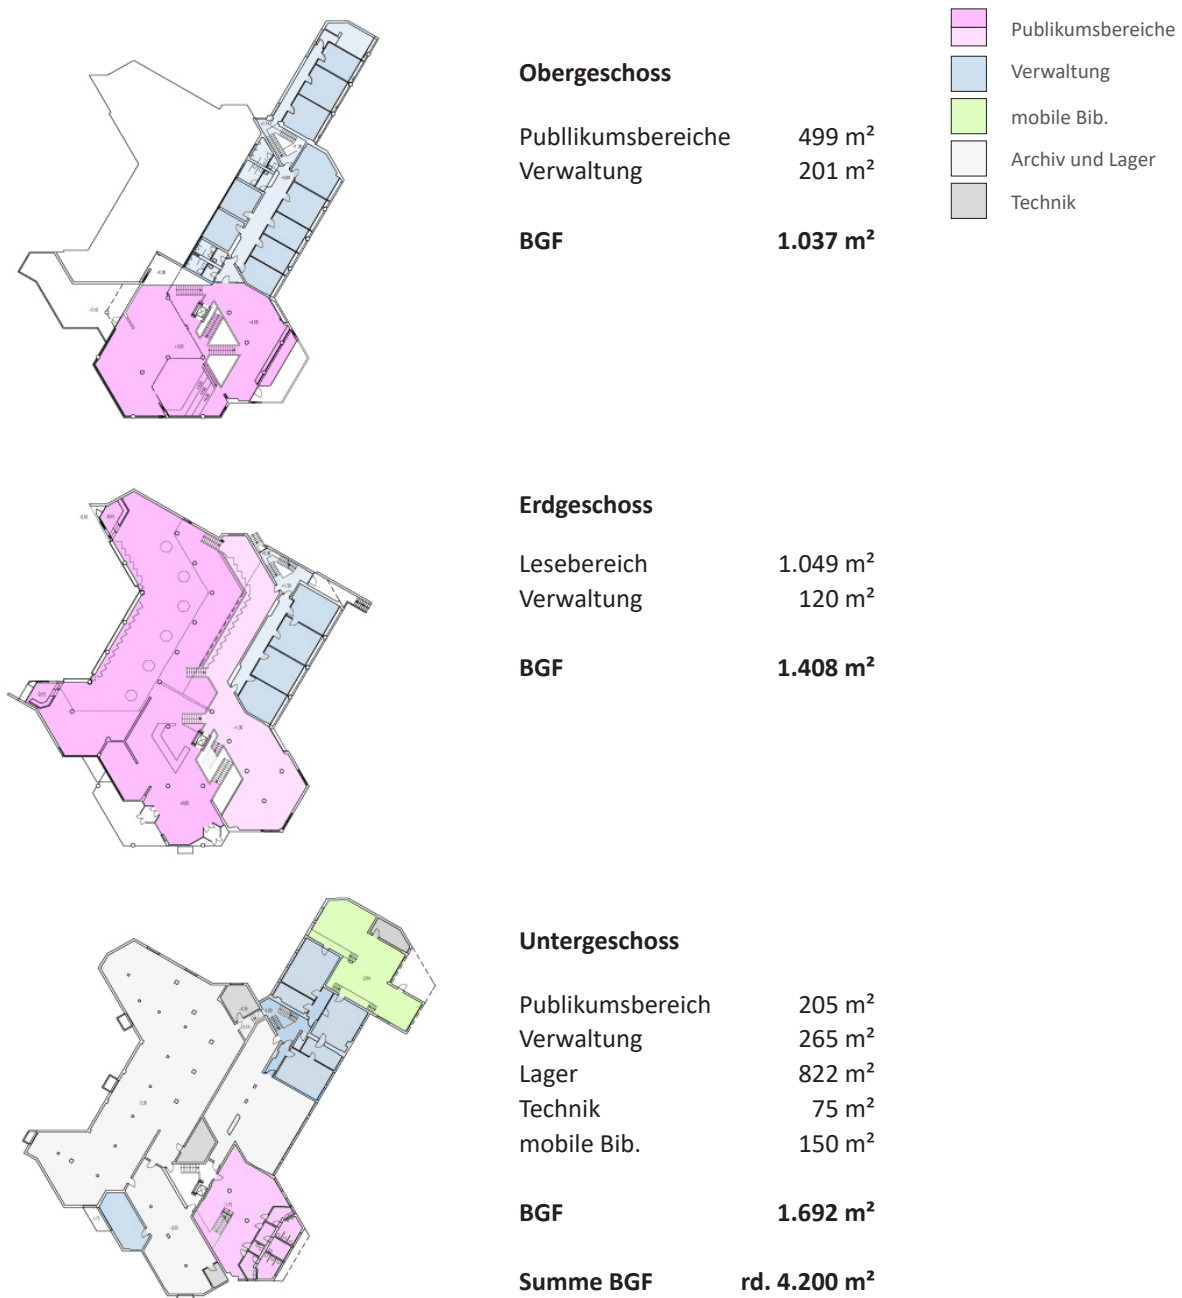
Grundrissanalyse Bibliothek mit Flächenberechnung
